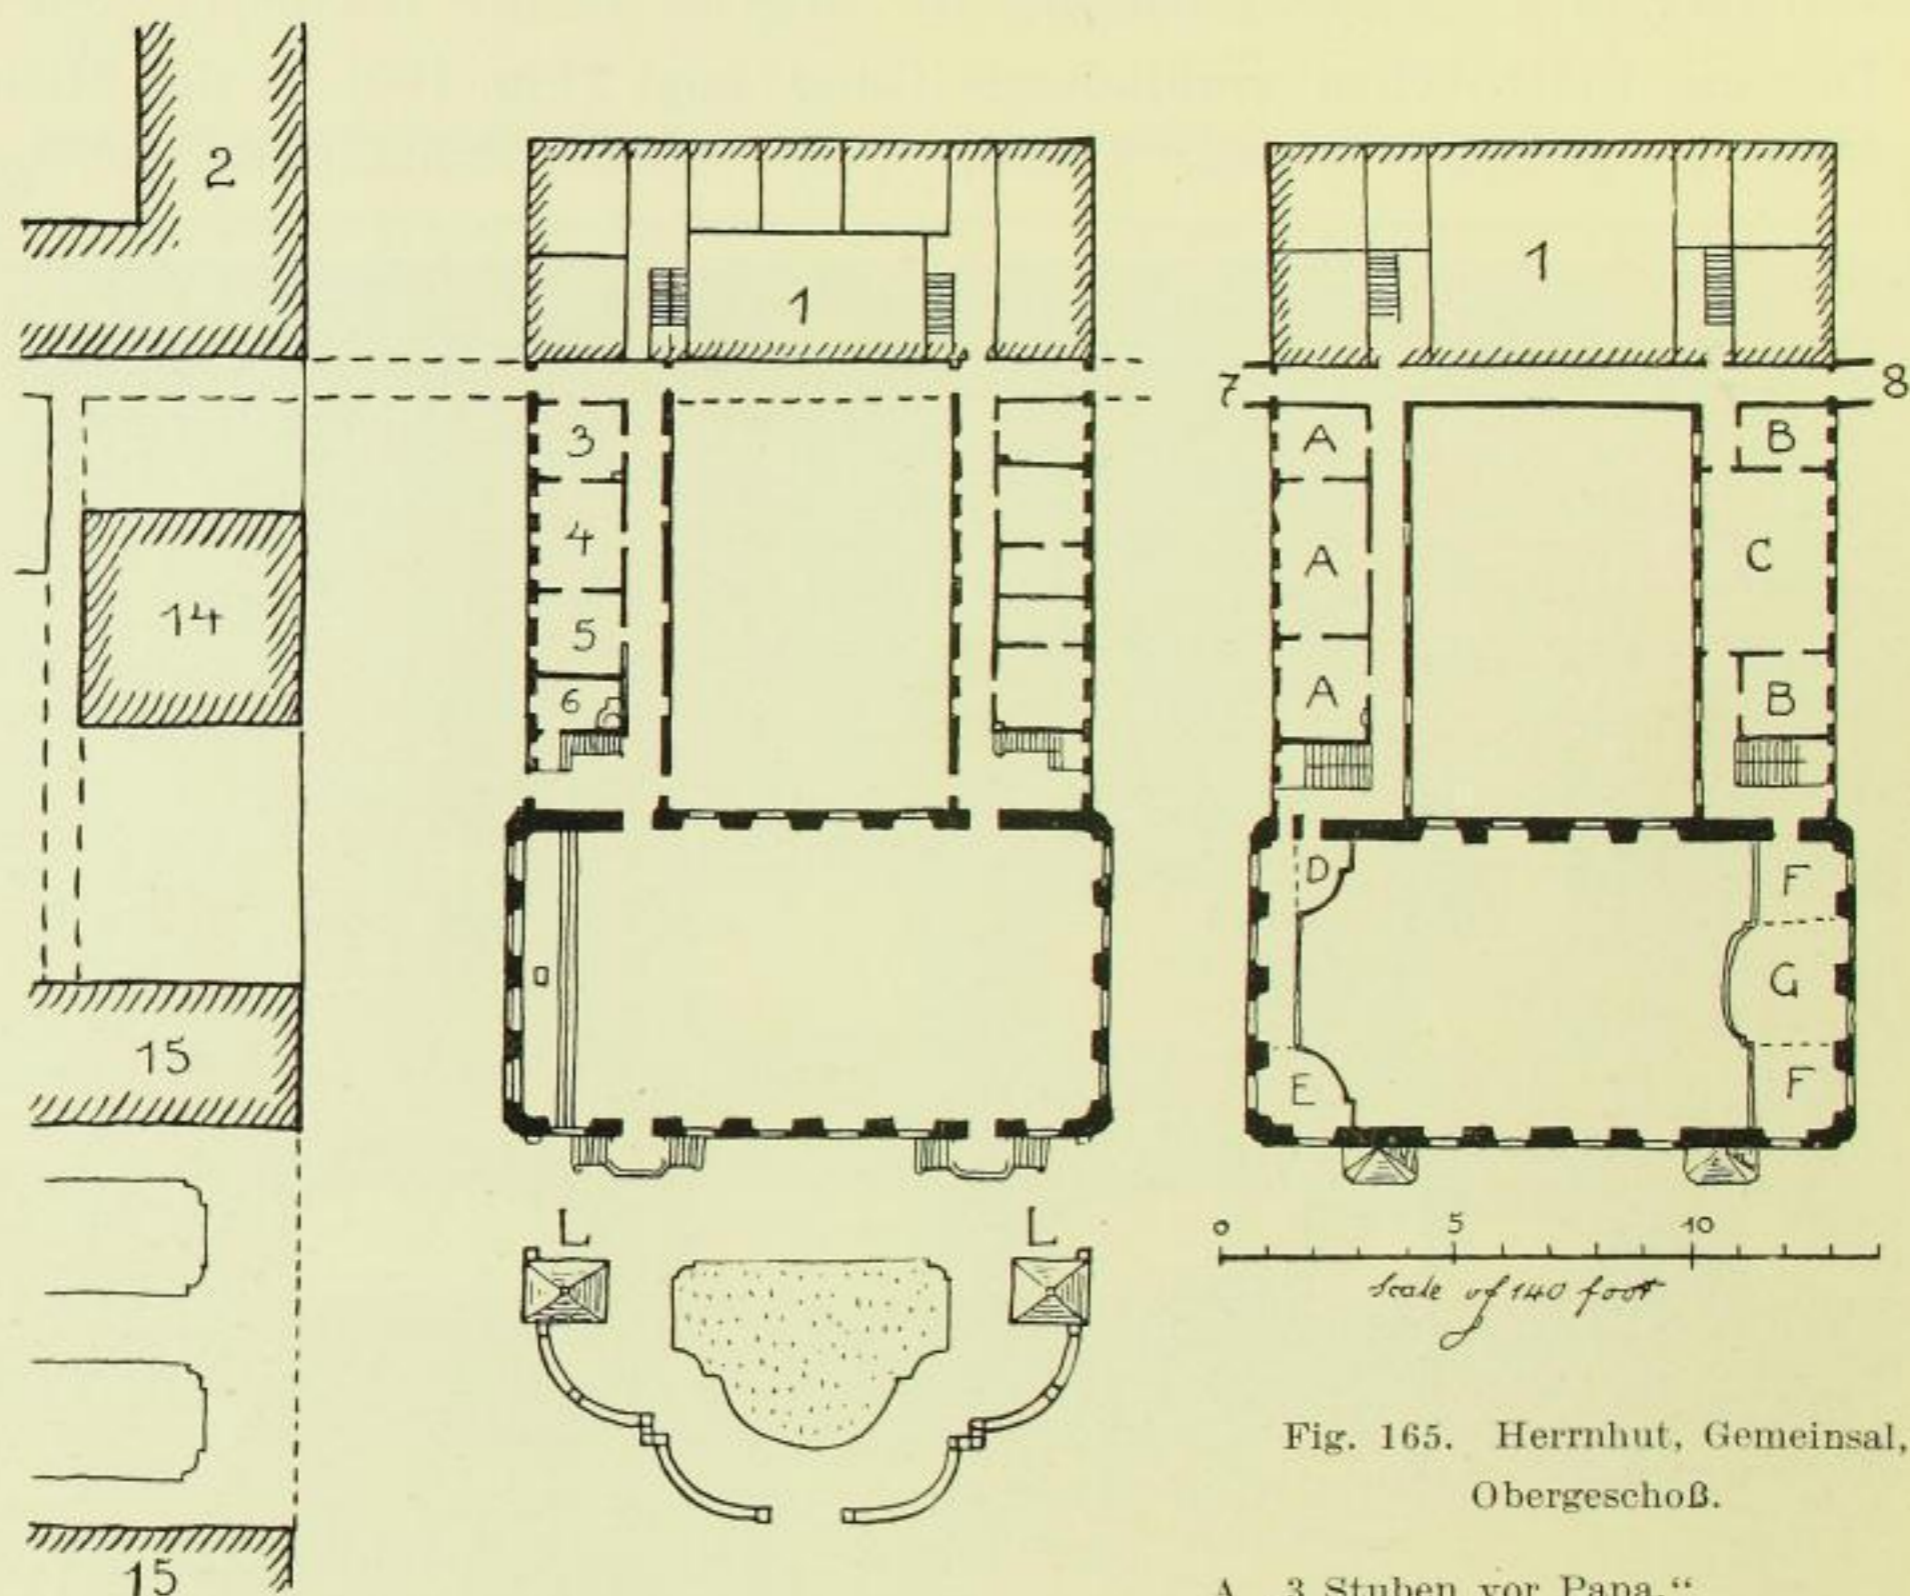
Herrnhut, Gemeinnsaal mit anschließenden Gebäuden. Erdgeschoß. Nach altem Plan.
